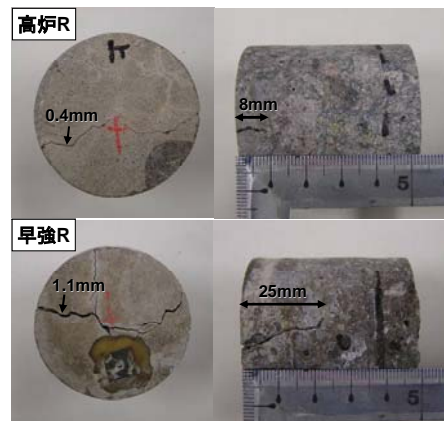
部材鉛直方向から採取したコアのひび割れの状況
